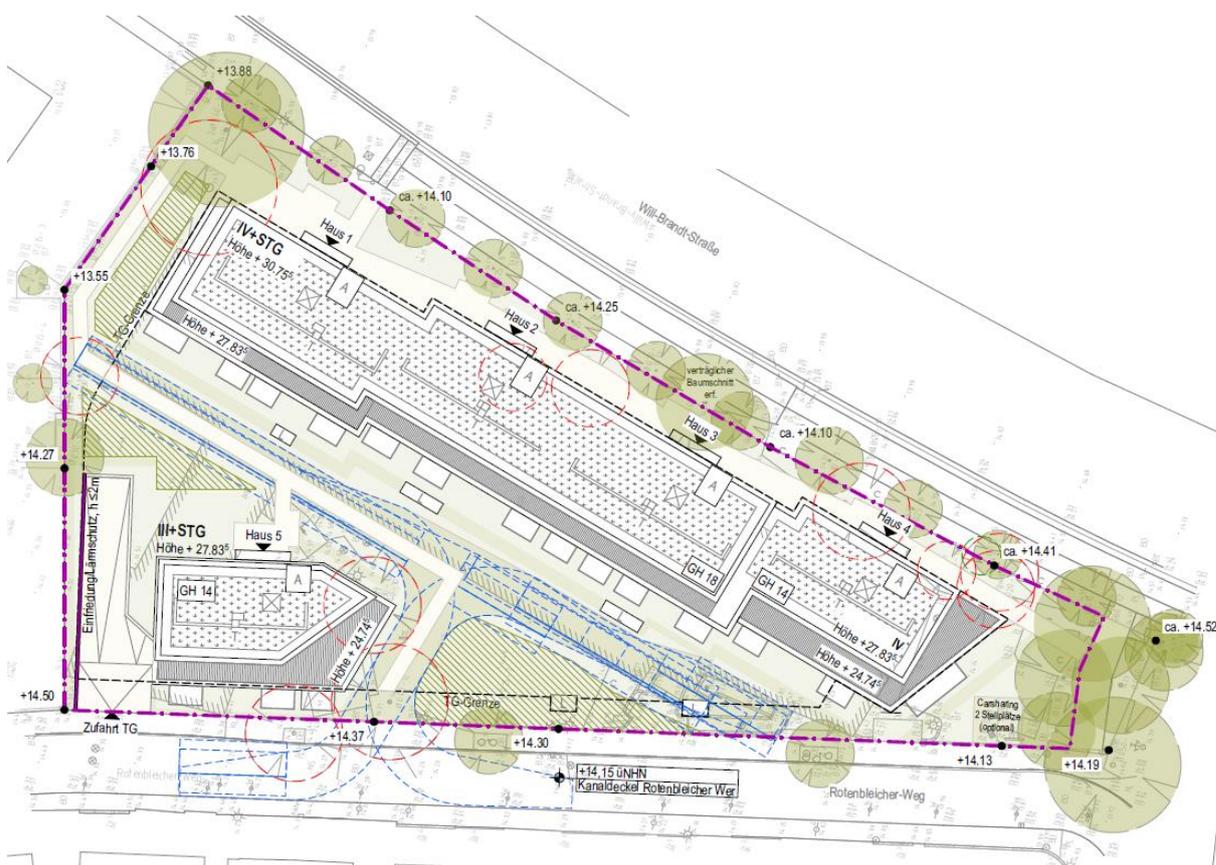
Funktionsplan Lageplan VEP, Auszug (Schenk + Waiblinger Architekten, 26.04.2019)
